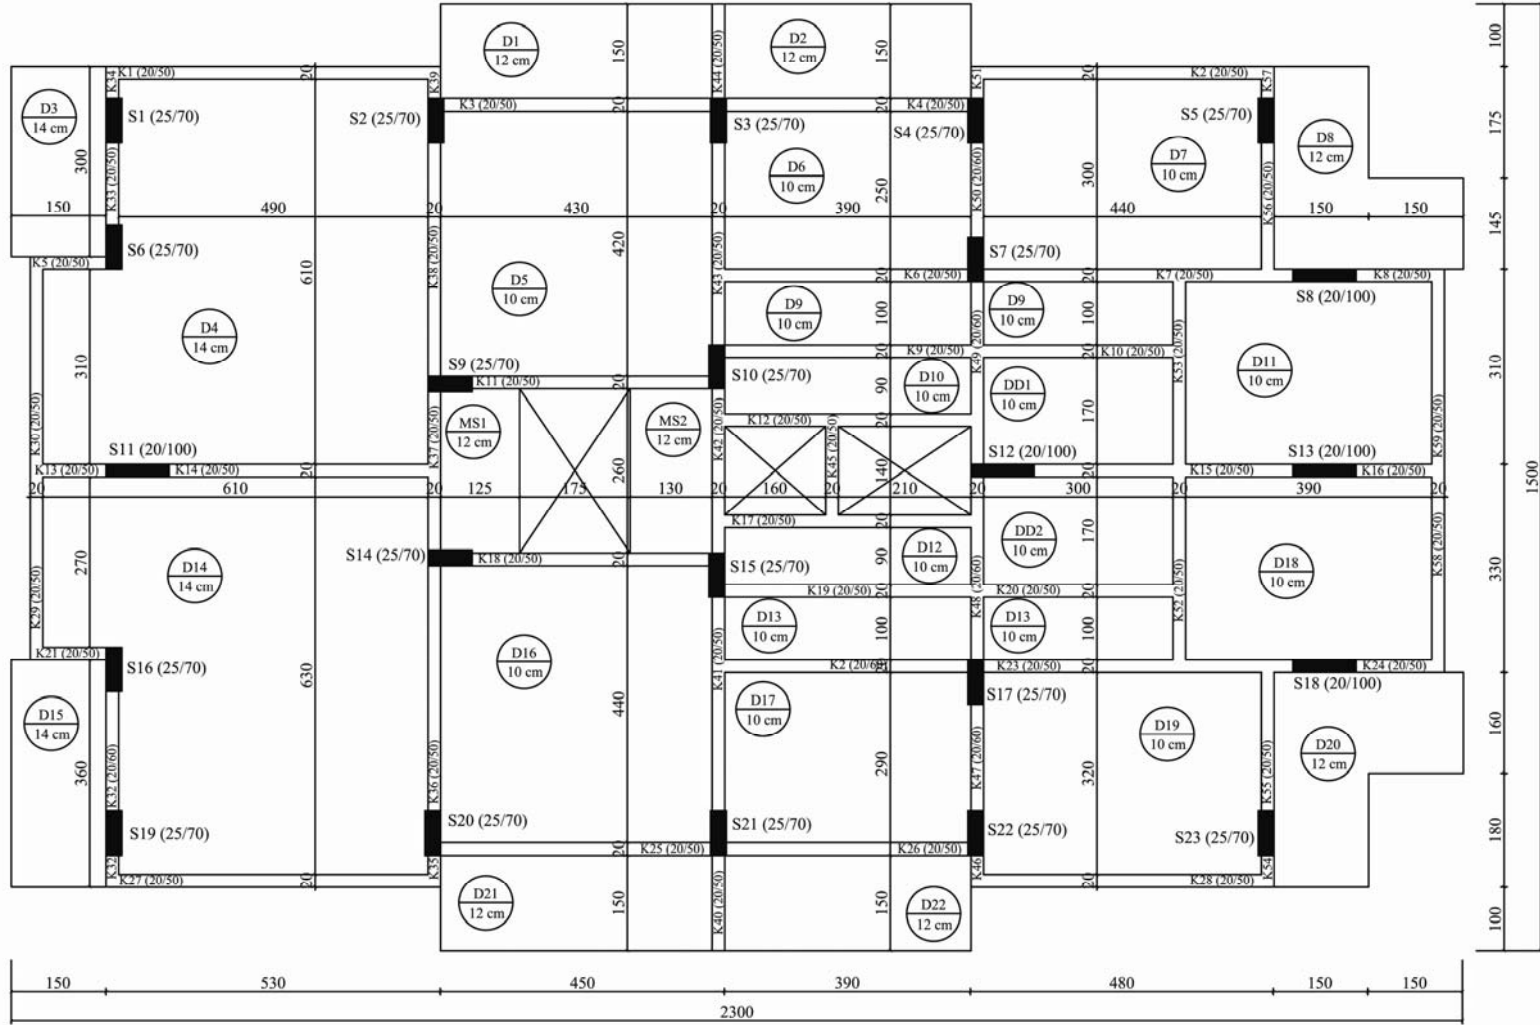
B6\_2'in kat kalıp planı
